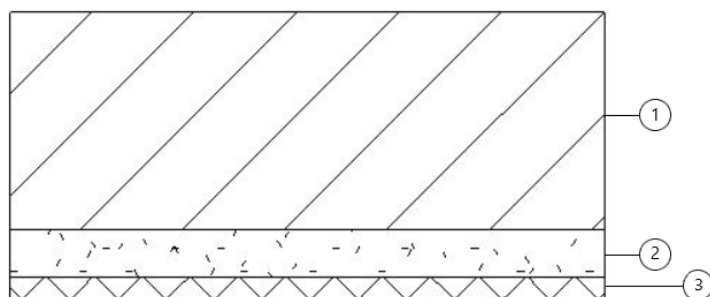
Pormenor da constituição da parede externa tipo E3
